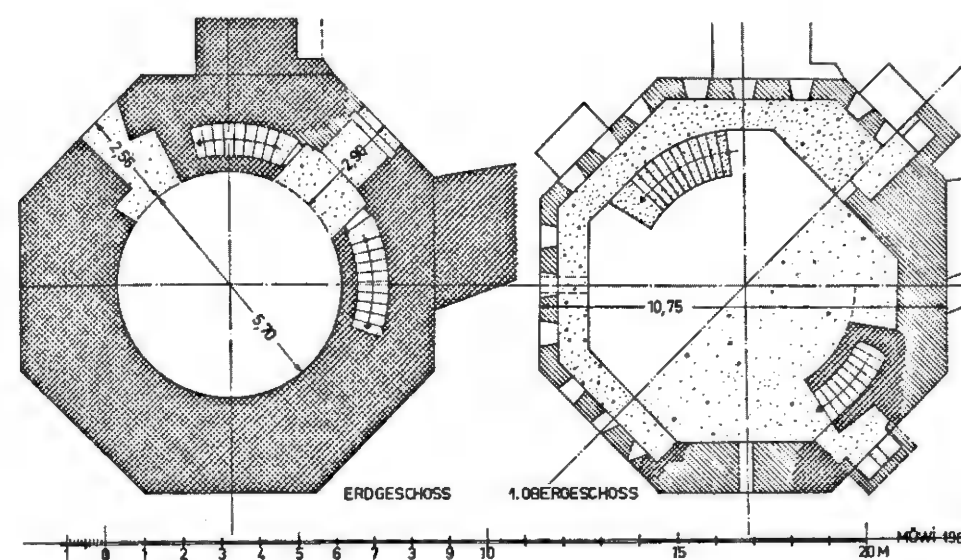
Grundrisse des südwestlichen Eckturmes des Kastells von Siğacık, Maßstab 1 : 200. (Der Grundriß des Obergeschosses ist diagonal geteilt – rechts das untere, links das obere Plattformgeschoß)
